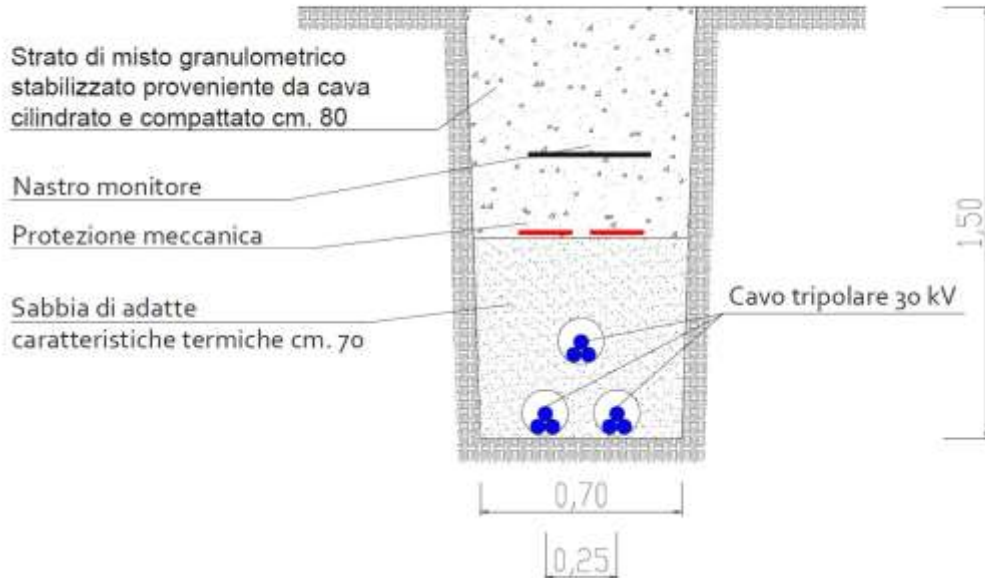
Sezione della trincea di scavo per la posa di n. 3 cavi da 30kV di collegamento dall'impianto FV alla Stazione di Elevazione – su terreno agricolo
